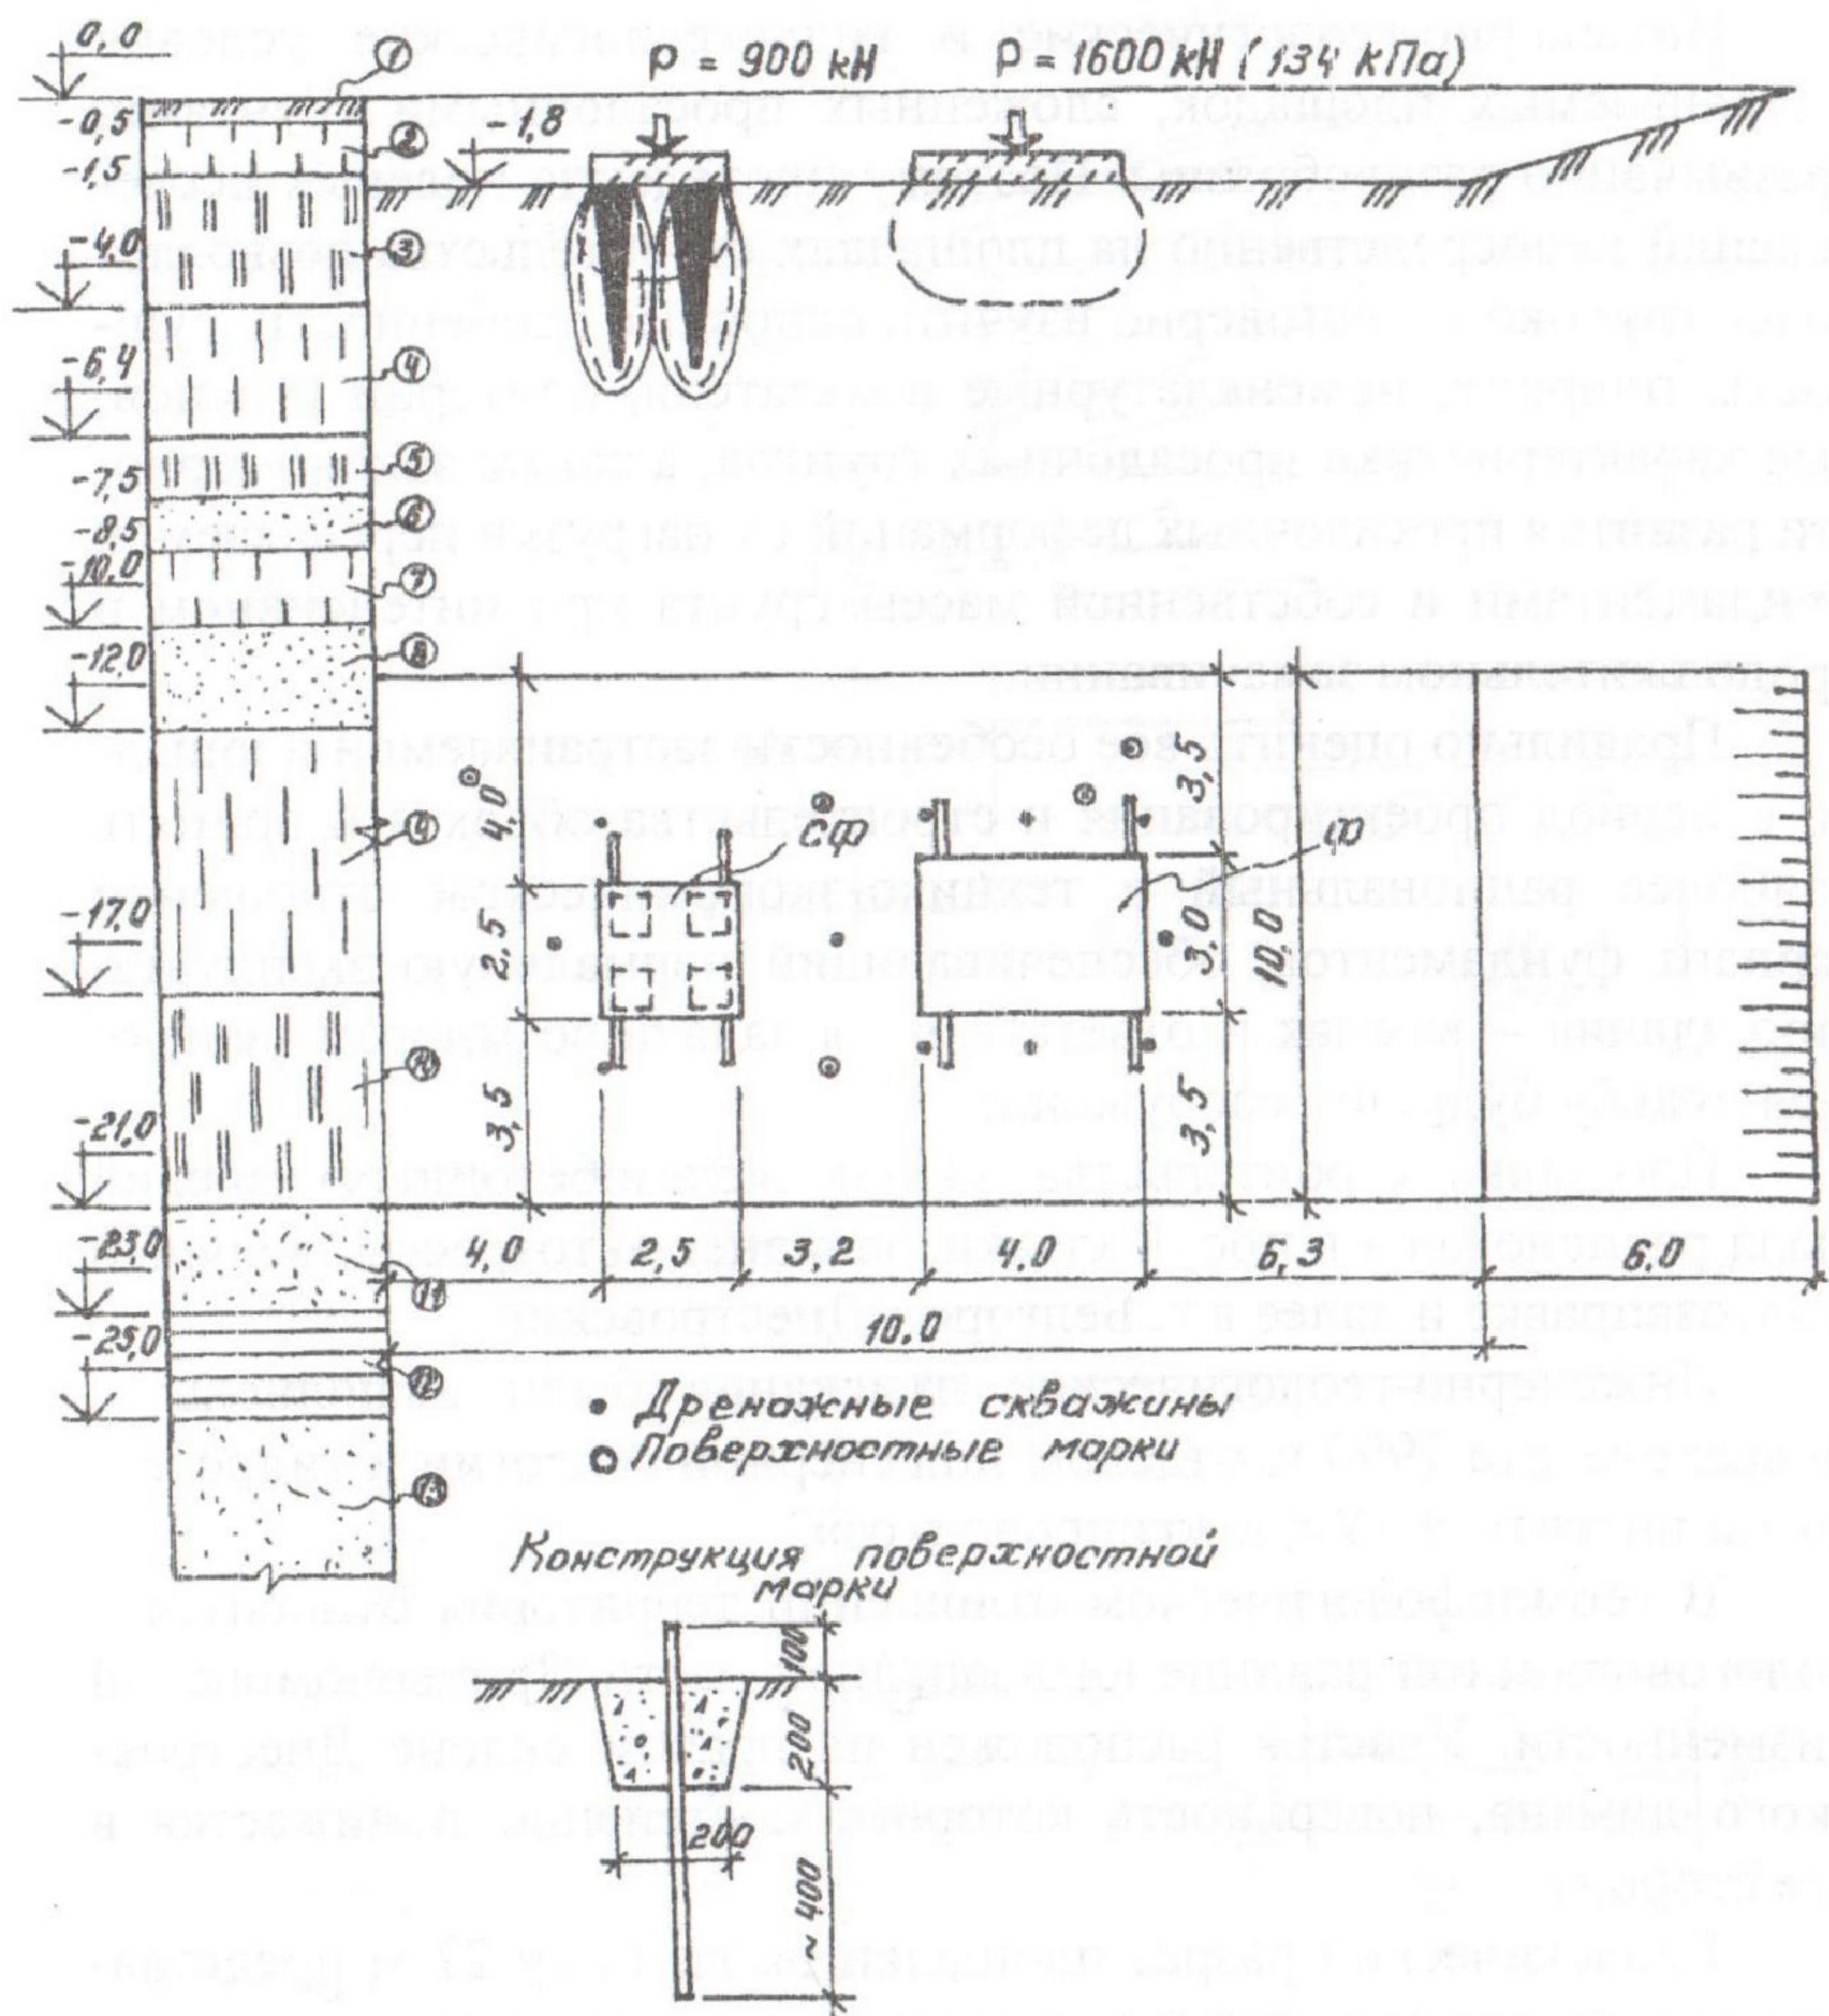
Инженерно-геологический разрез и схема расположения опытных фундаментов.
